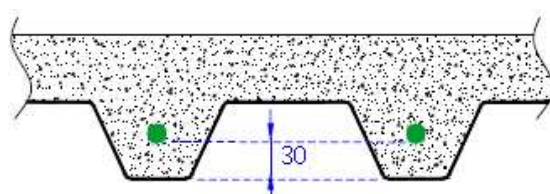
Disposição de armadura adicional em lajes mistas aço-betão (Figueiras *et al*, 2006).
